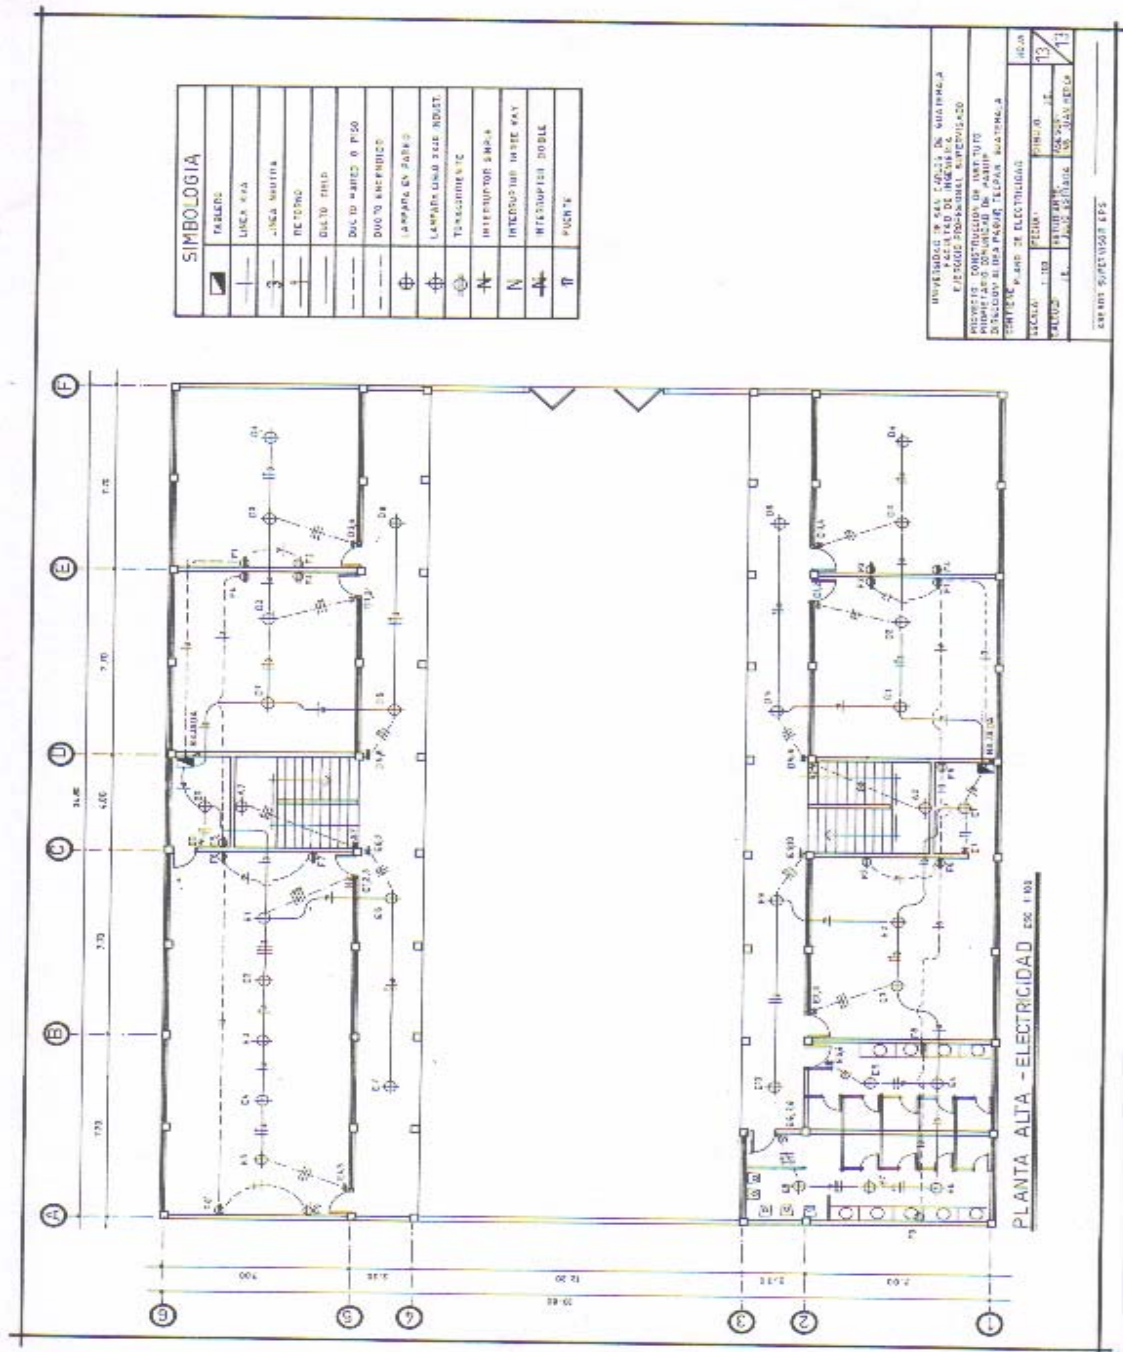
Plano de electricidad, planta alta – edificio de aulas
